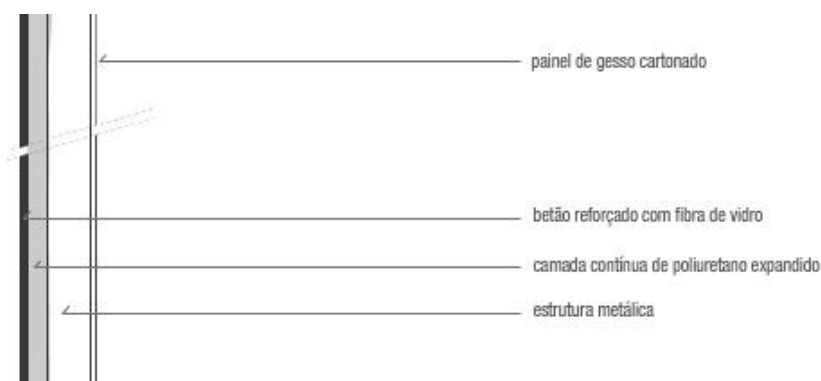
Parede exterior em betão reforçado com fibra de vidro (SIT, 2011)
